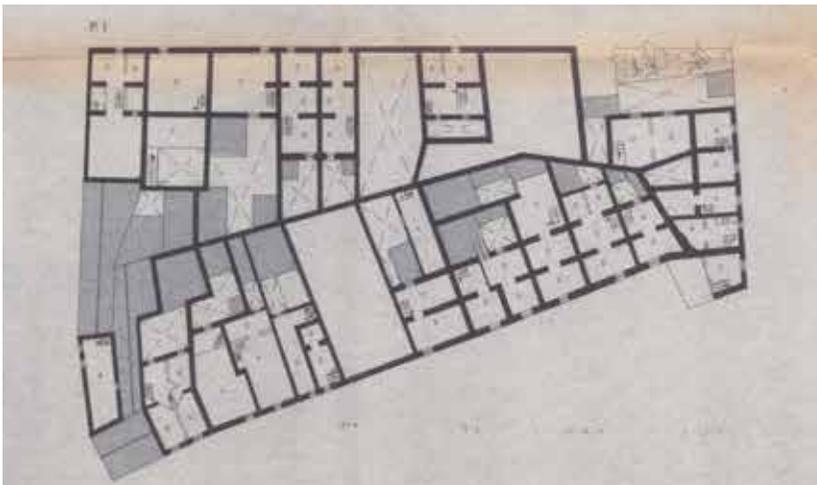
Planta primera. Estudio de Manzana - NNS, plano IV.1.4.2. Fuente: Ayuntamiento de Gaucín, 1986
